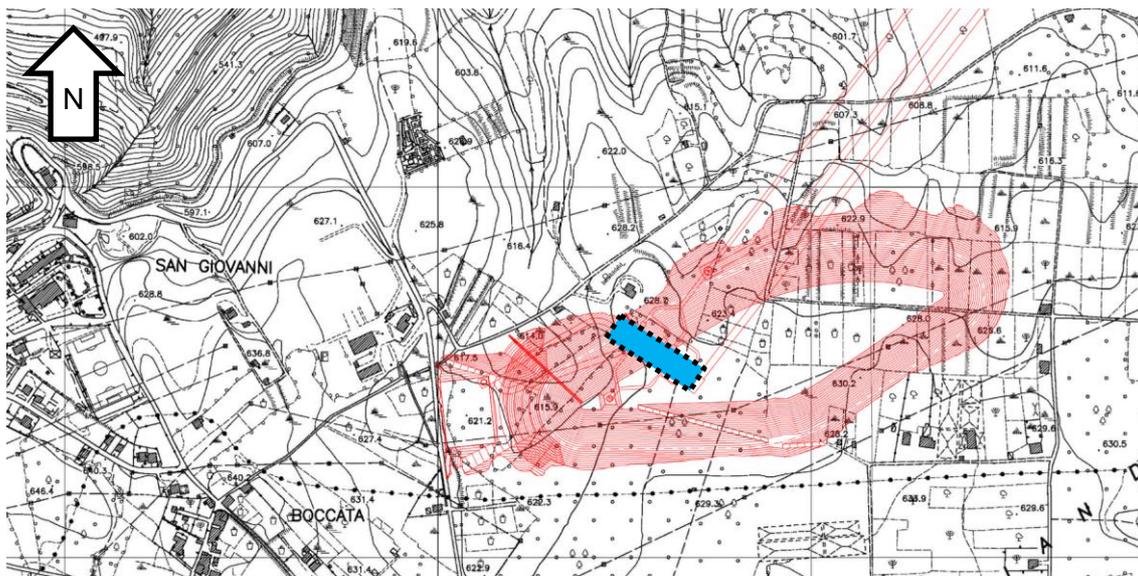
Polilinee rosse: bacino di monte. Rettangolo blu: ubicazione planimetrica della centrale in caverna, su base CTR 1:10.000.
